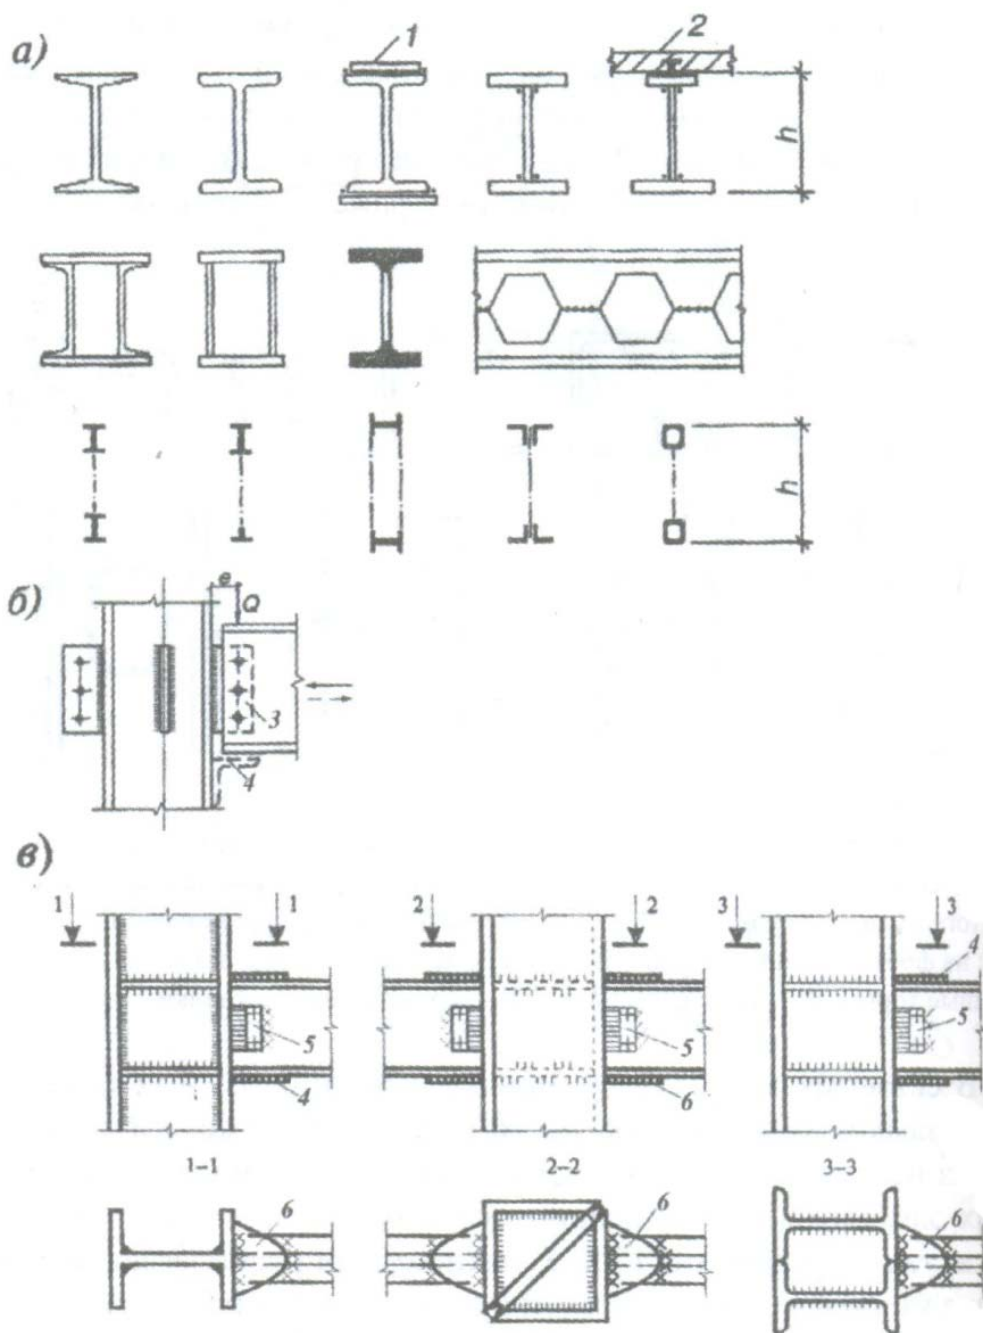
Типы сечений балок перекрытий и крепление к колоннам:
